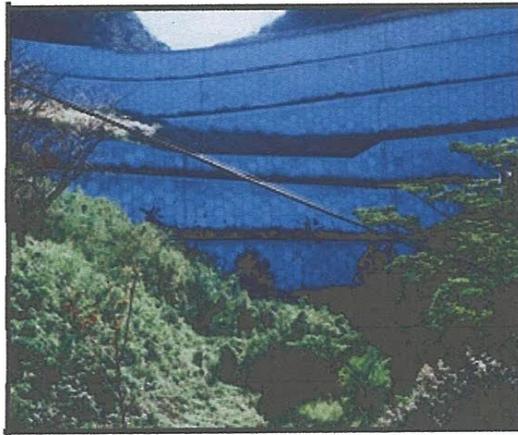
Mur de 57 m de haut - Ehime Shikoku (Japon)
